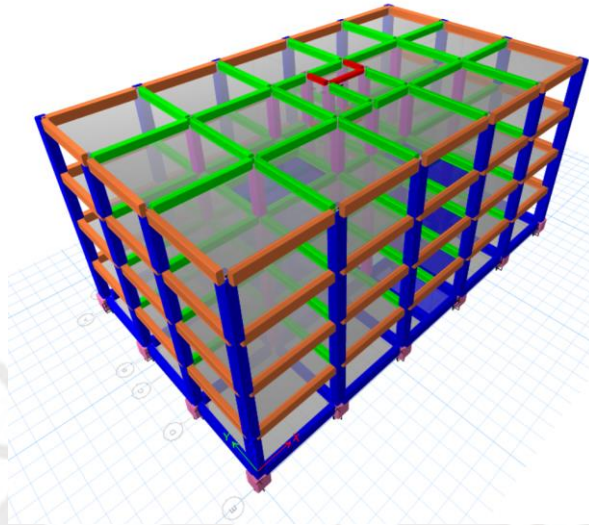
Vista 3D del modelo tridimensional del edificio con base aislada
